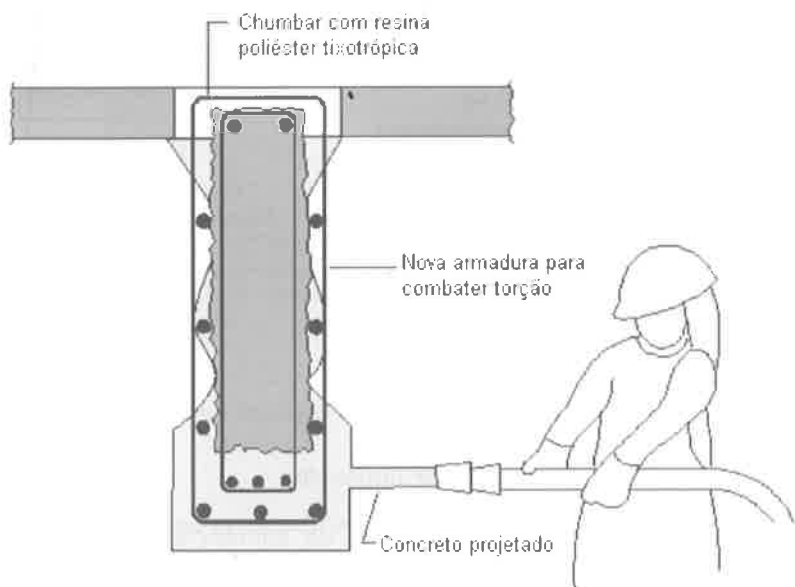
Reforço de torção em vigas com concreto projetado.
